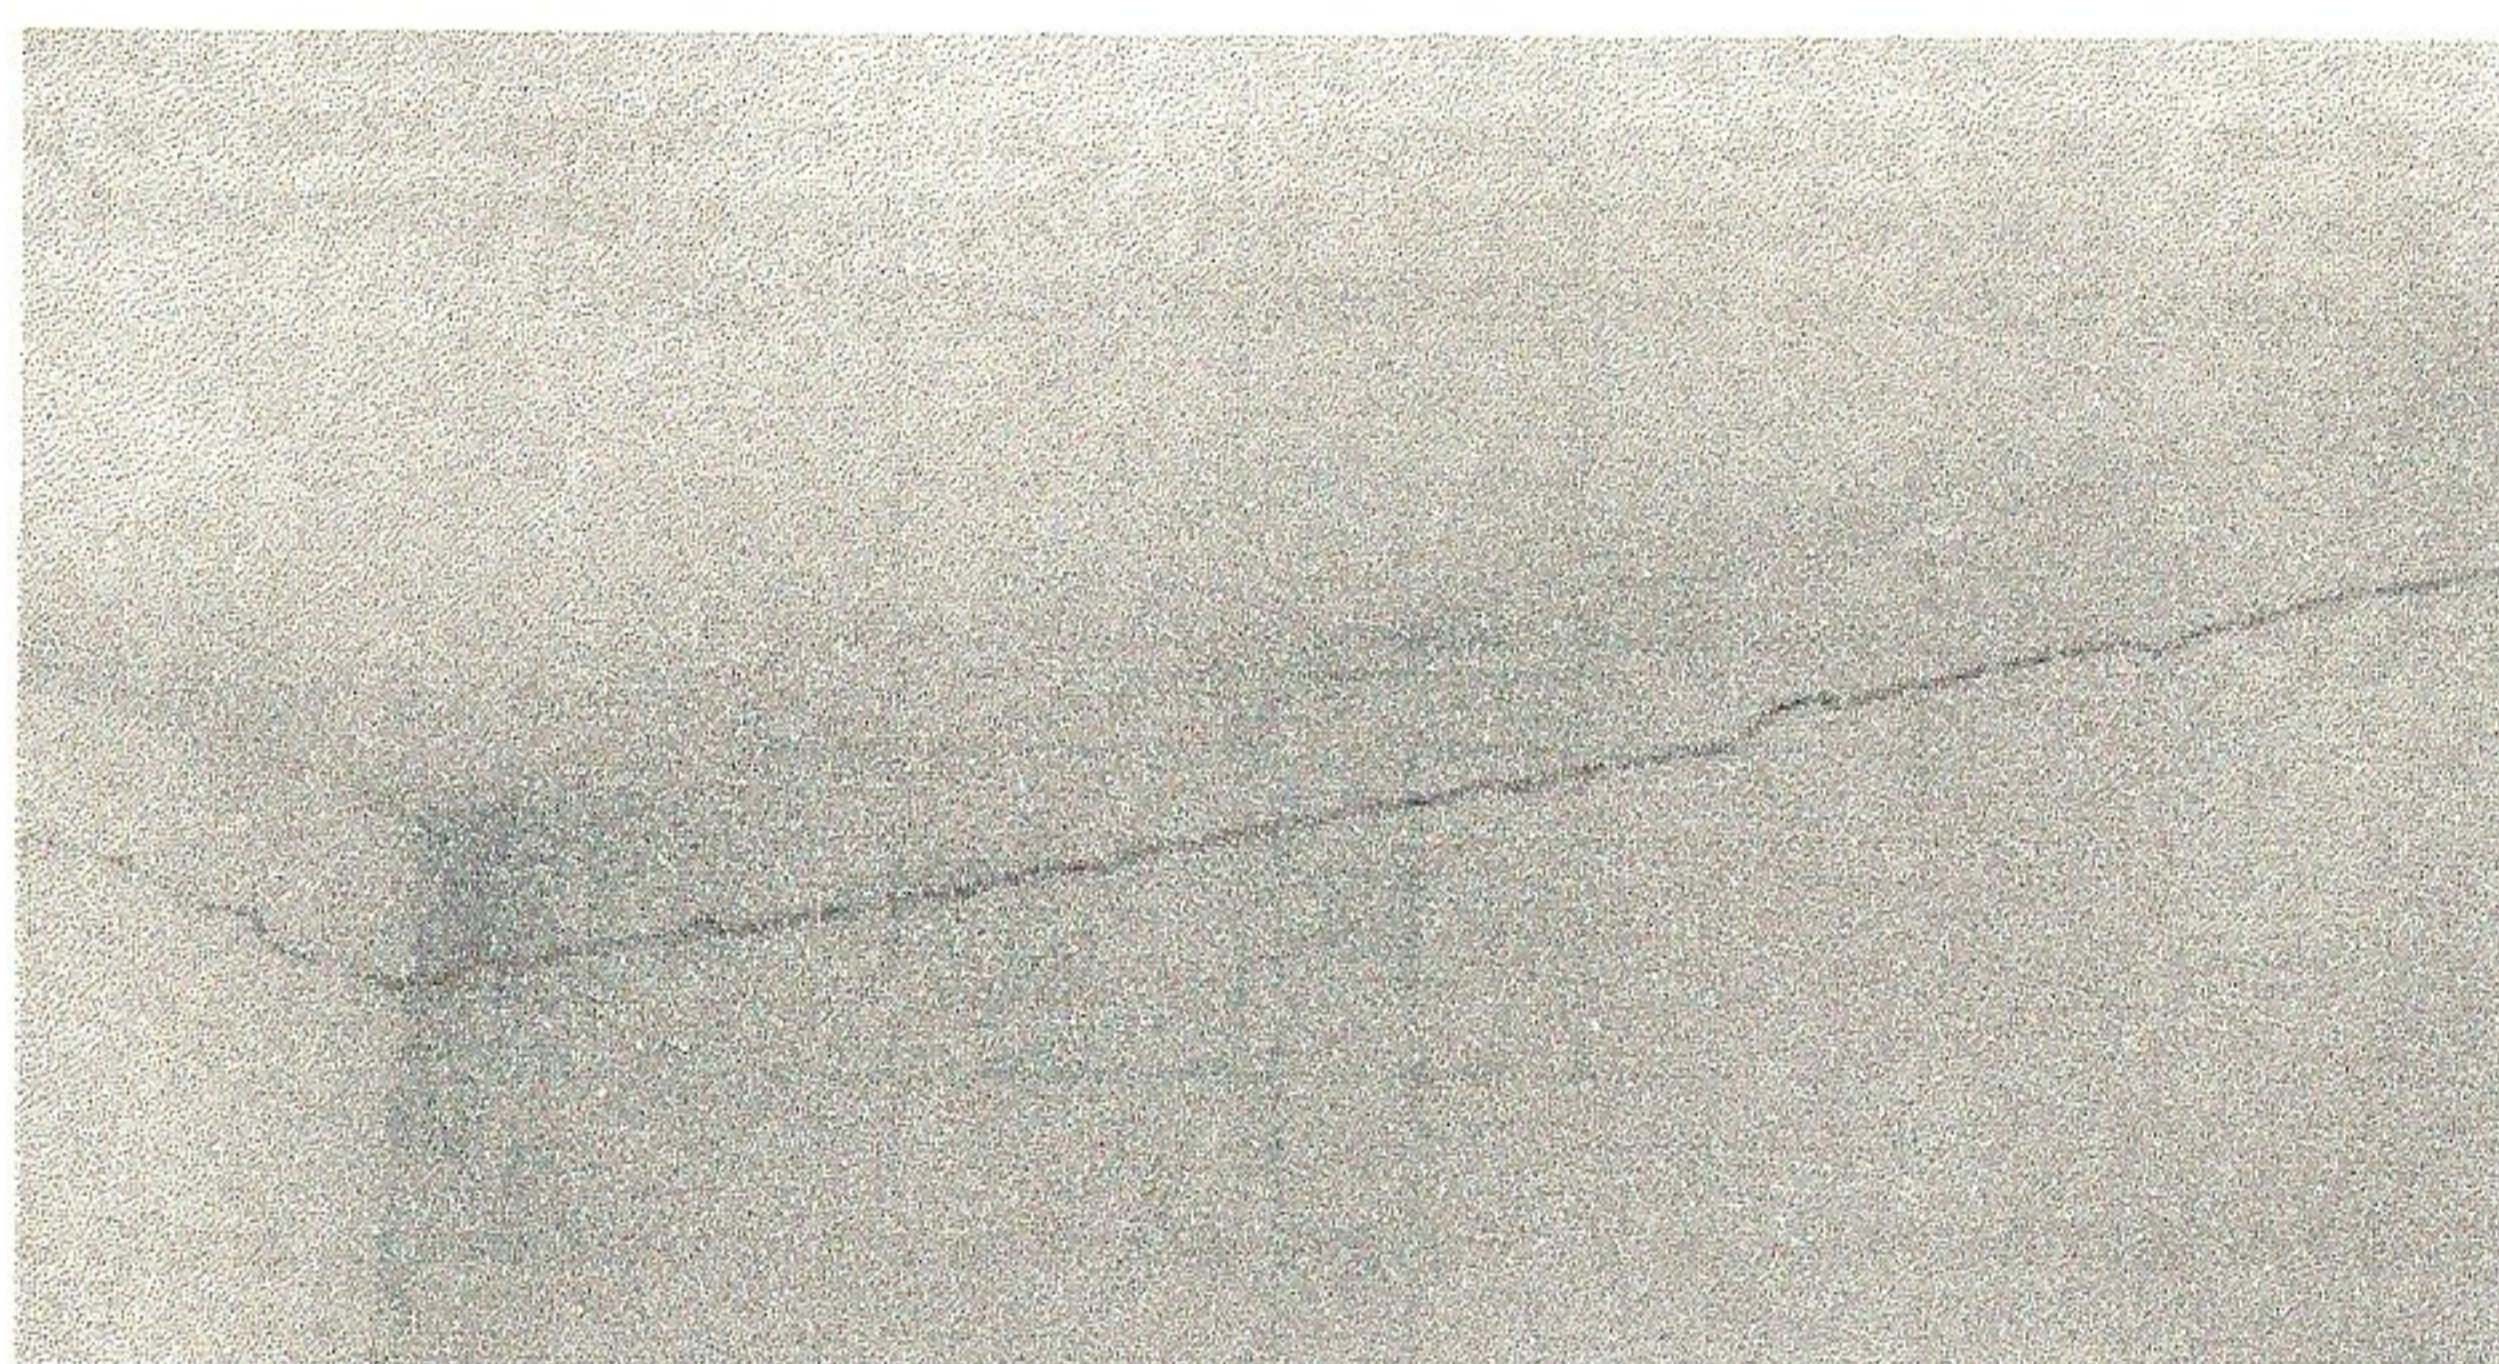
Alvenaria com fissuras inclinadas, em forma de escama, evidenciando a dilatação térmica da laje de cobertura. [22]
